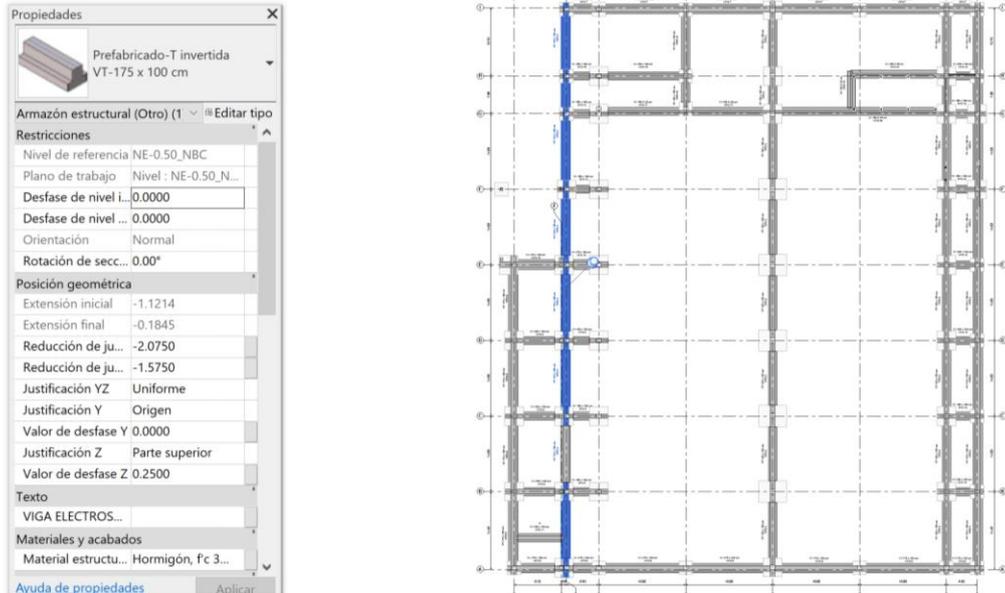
Planta de vigas de cimentación, fuente Modelo estructural propia
